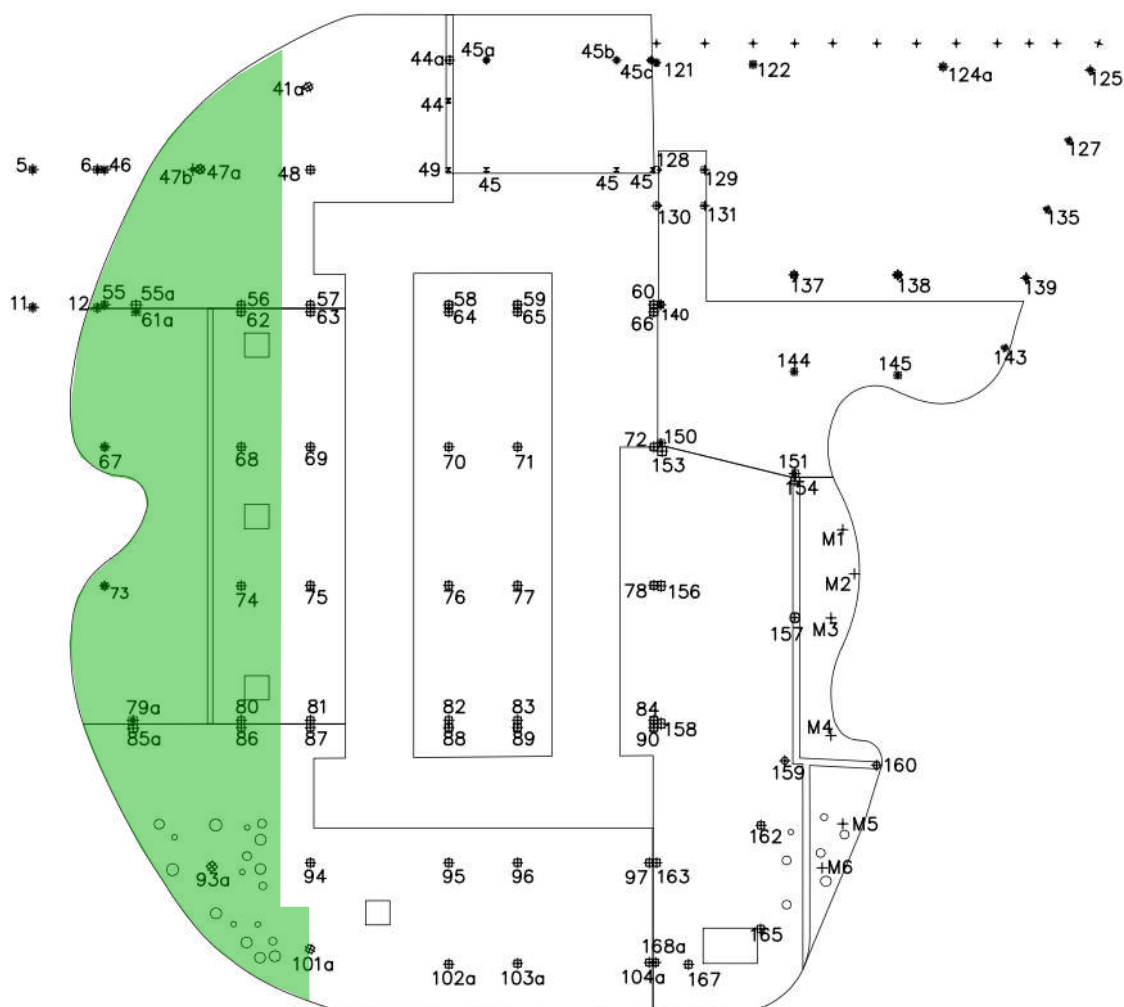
Esquema de distribución de pilares existentes. En verde el área de actuación
